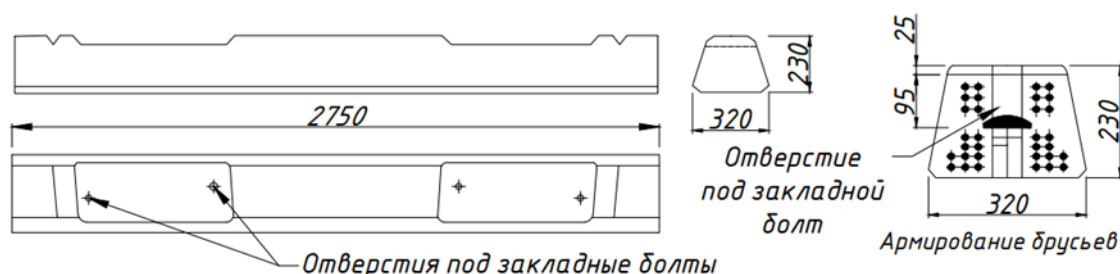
Общий вид бруса и расположение армирующих элементов
